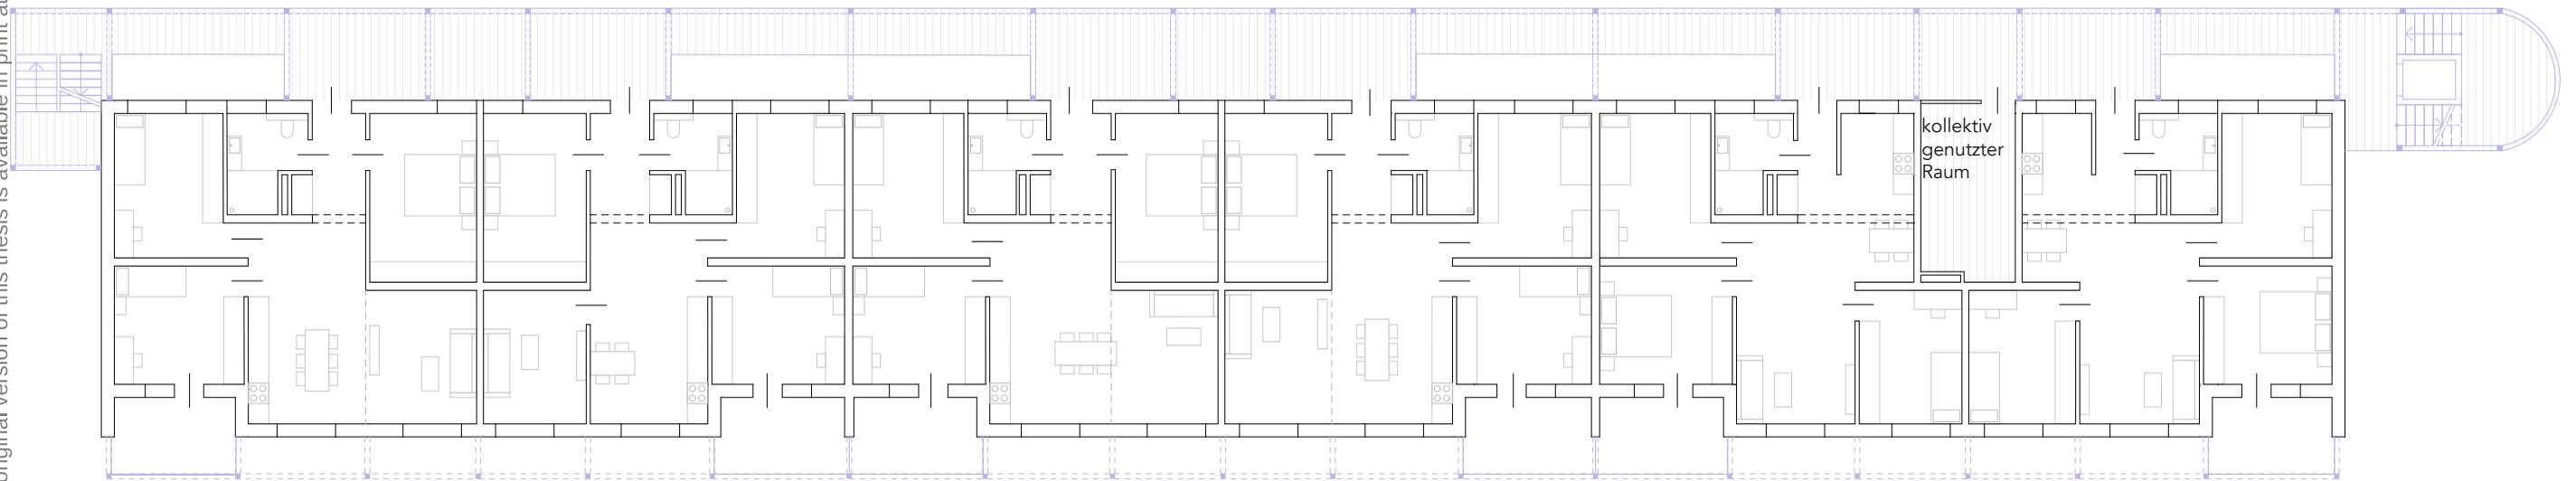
Grundriss Aufstockung M 1:200
